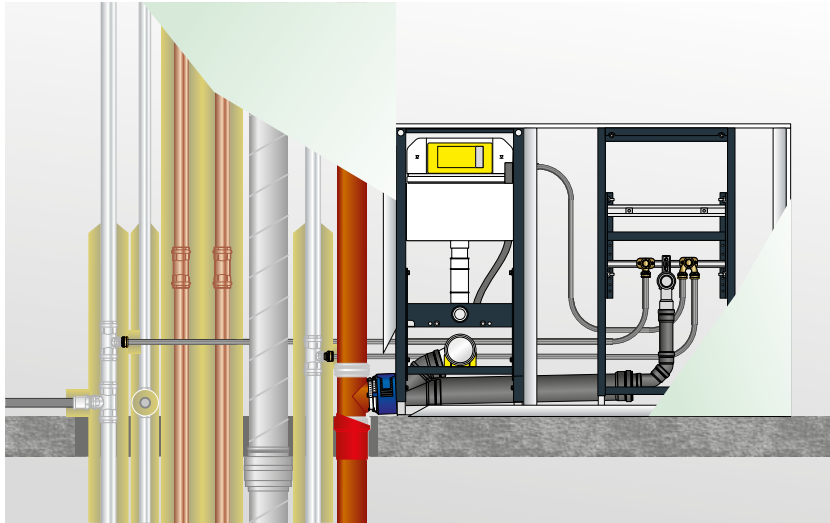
Schachtaufbau mit Guss-SML-Abwasserleitungen in Mischinstallation
